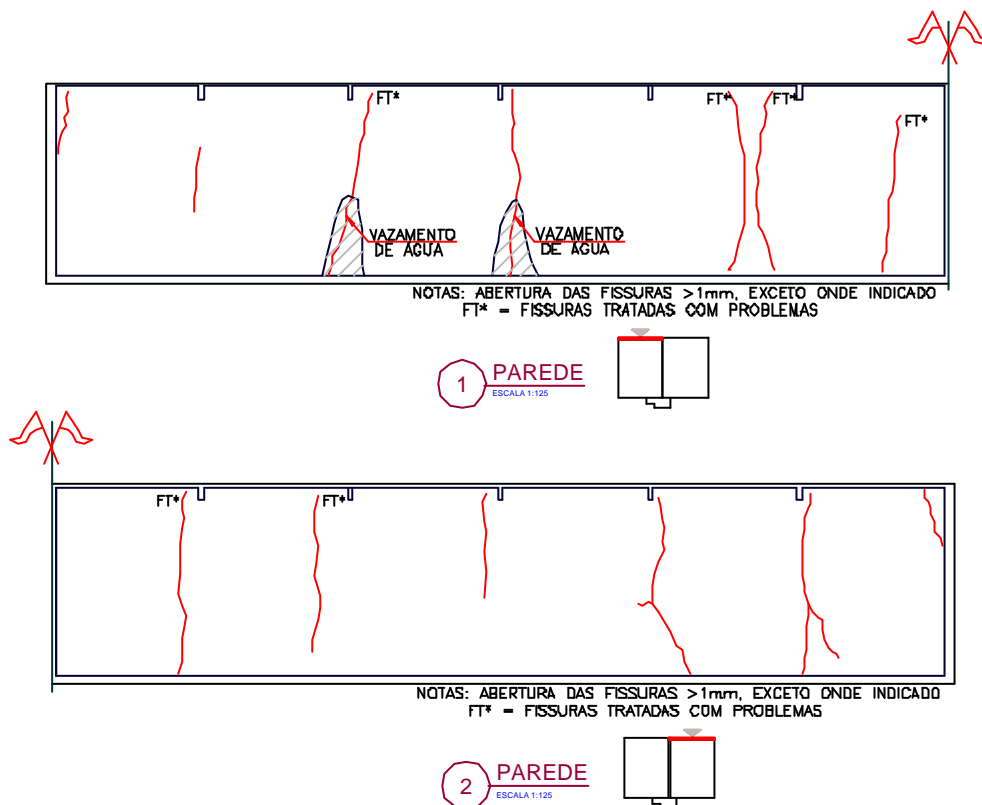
Mapeamento de fissuras nas paredes 1 e 2. (CHIMELLO, 2000).
